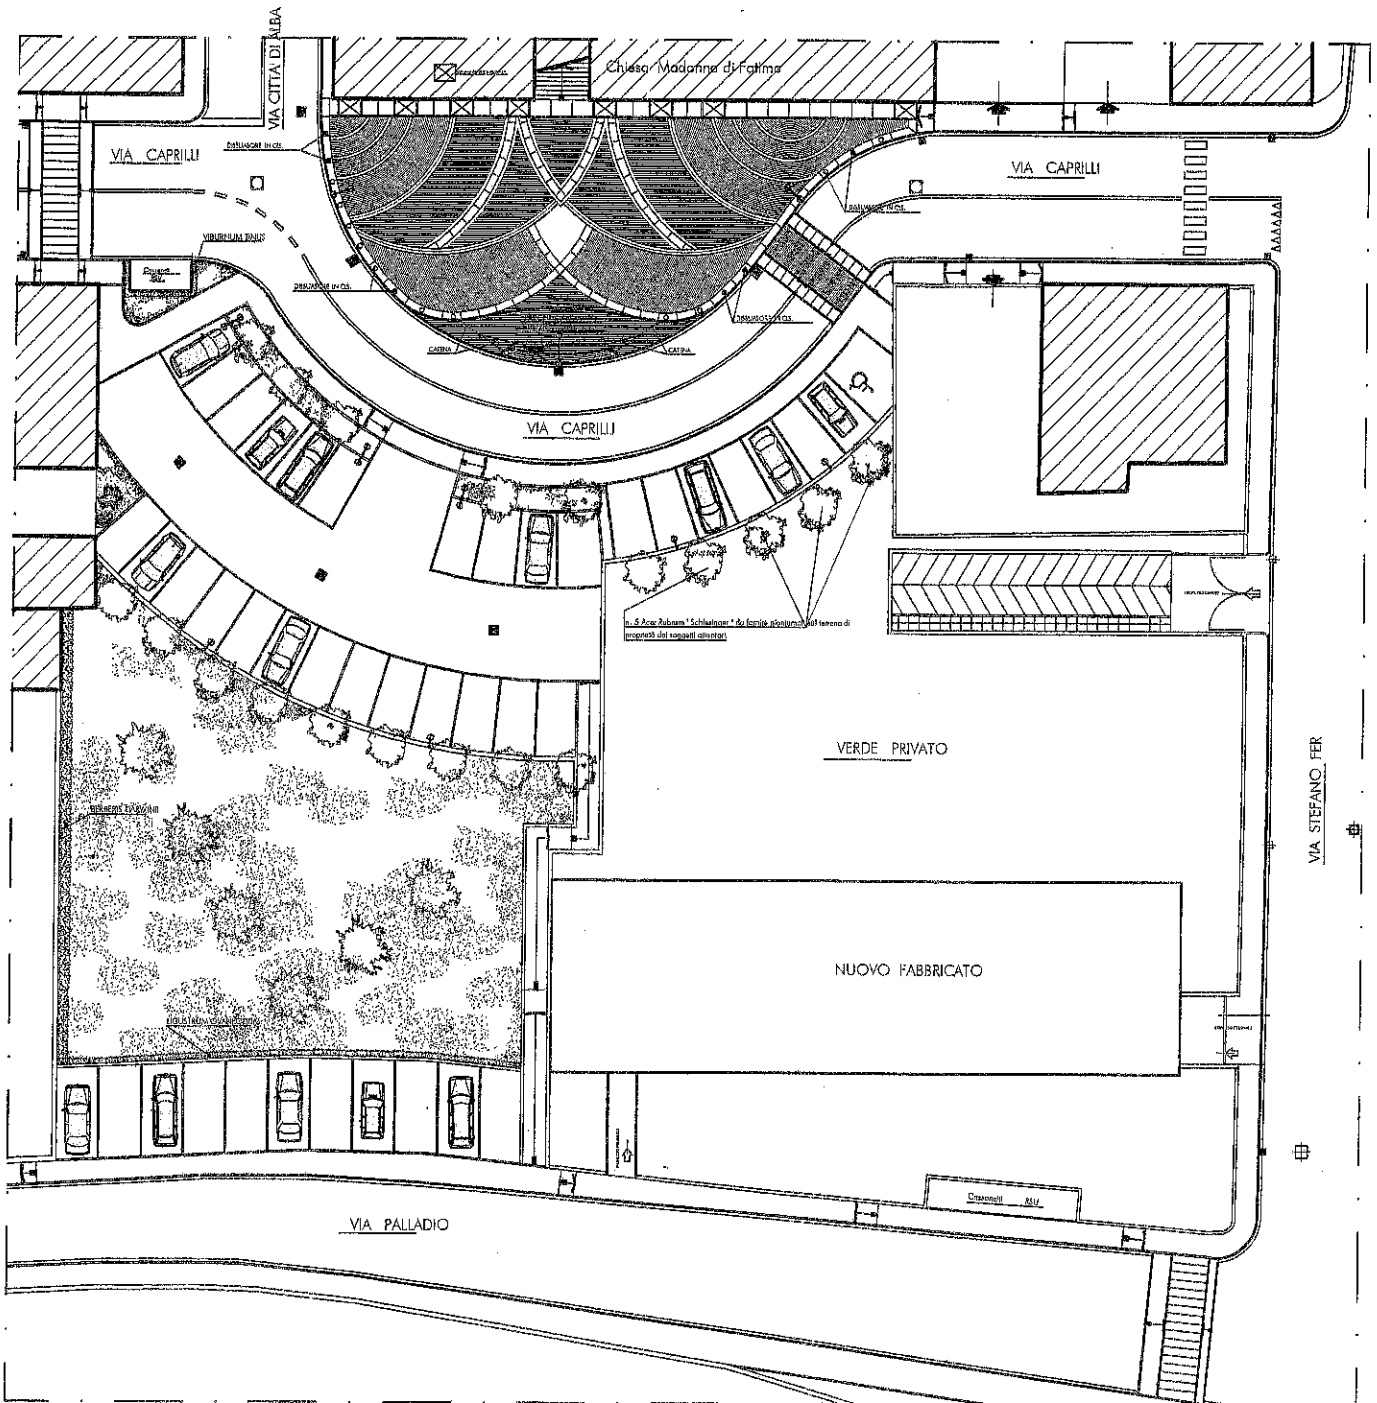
PLANIMETRIA AREA DA VARIANTE N.3 AL PEC
